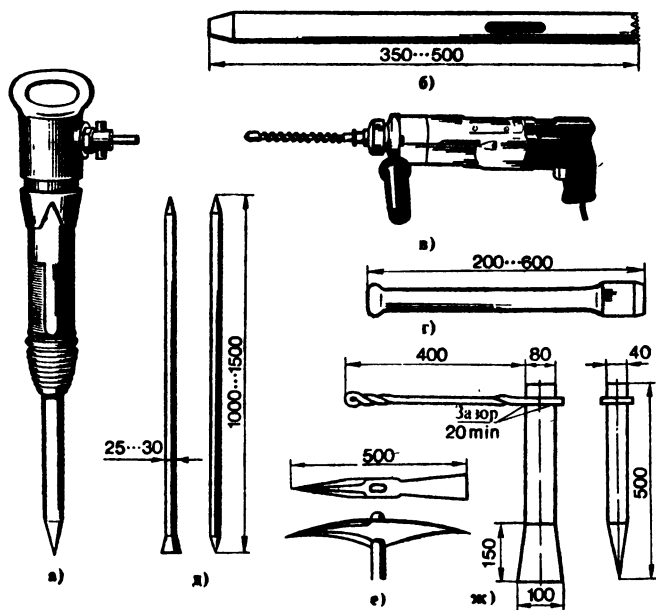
Инструменты для разборки и ремонта кладки: а — пневматический отбойный молоток, б — шлямбур, в — электрическая сверлящая машина, г — сверло, д — лом, е — кирка, ж — клин
